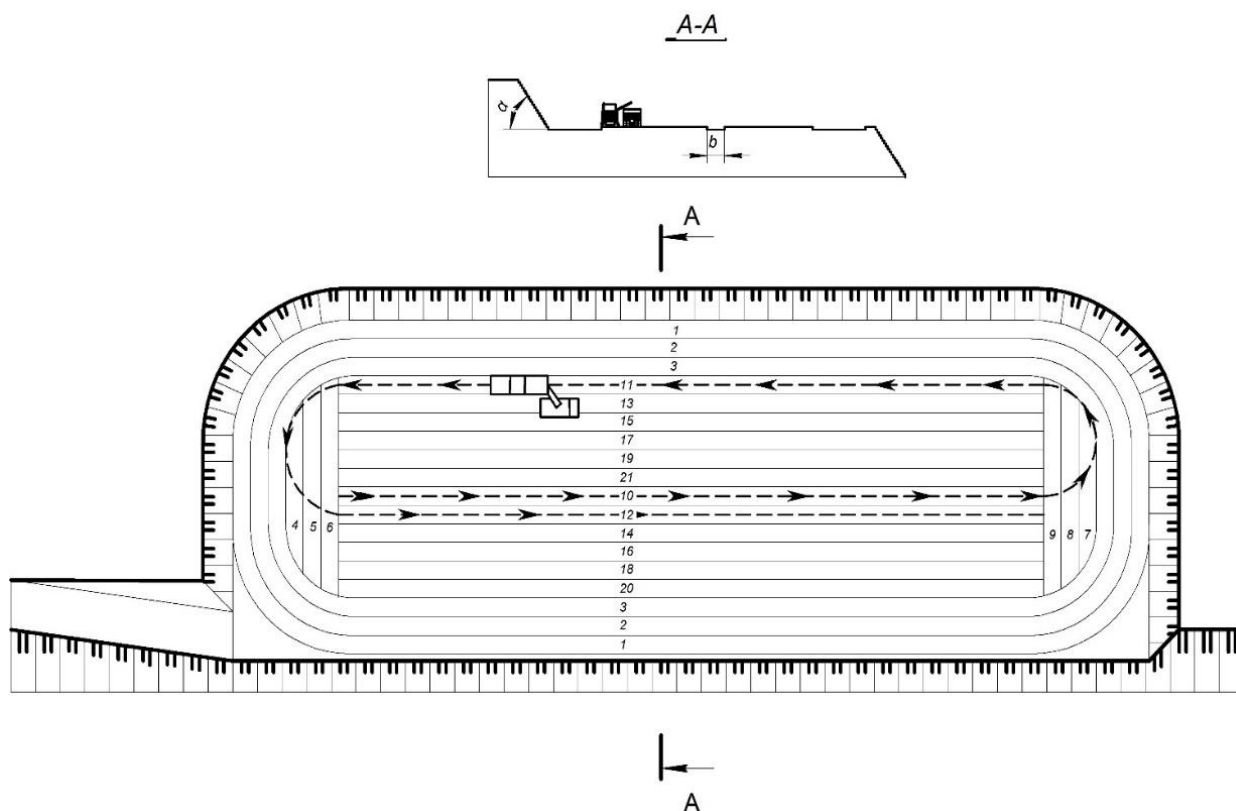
Поточкова схема роботи фрезерного комбайна по рухомій петлі
